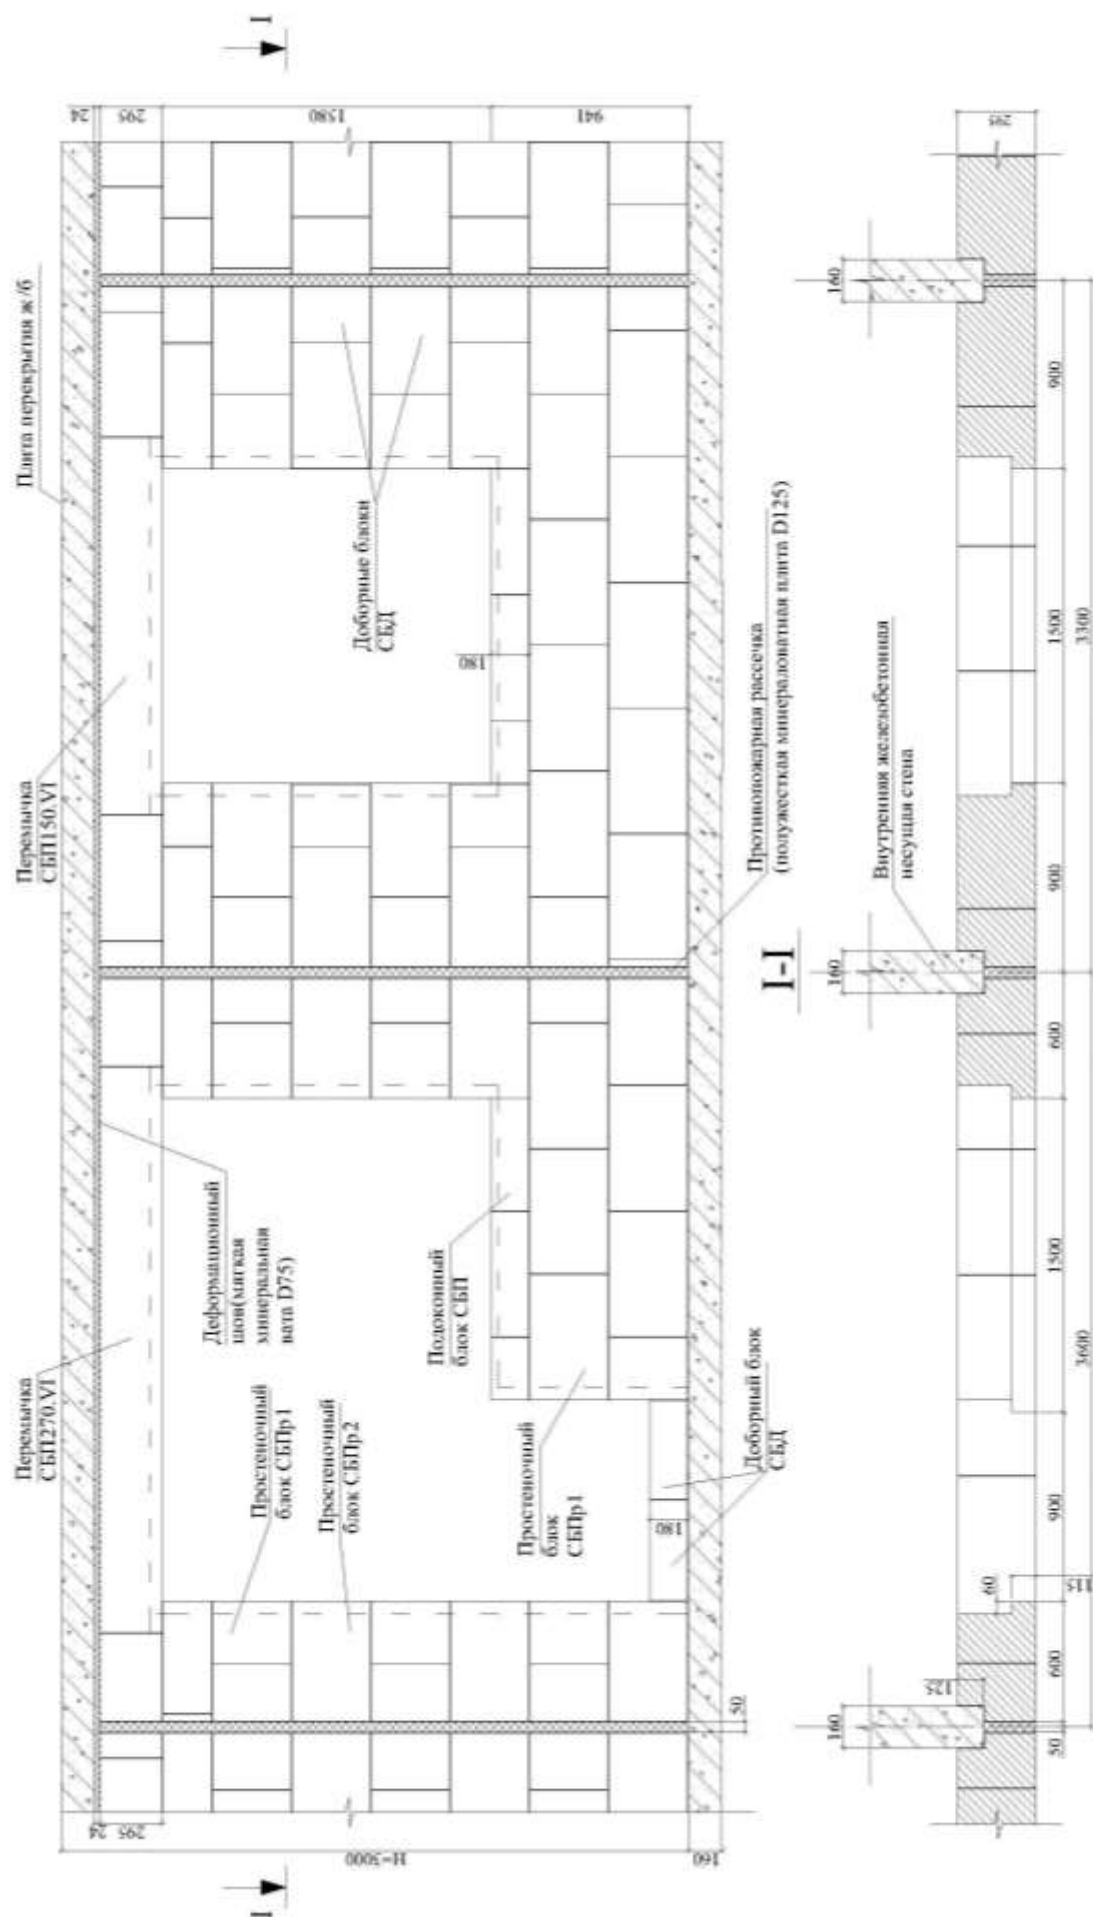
Пример раскладки ПСБ блоков и перемычек производства ЗАО "Юникон - ЗСК" при монтаже наружной стены здания с кирпичным фасадом (толщина блоков 295 мм)
